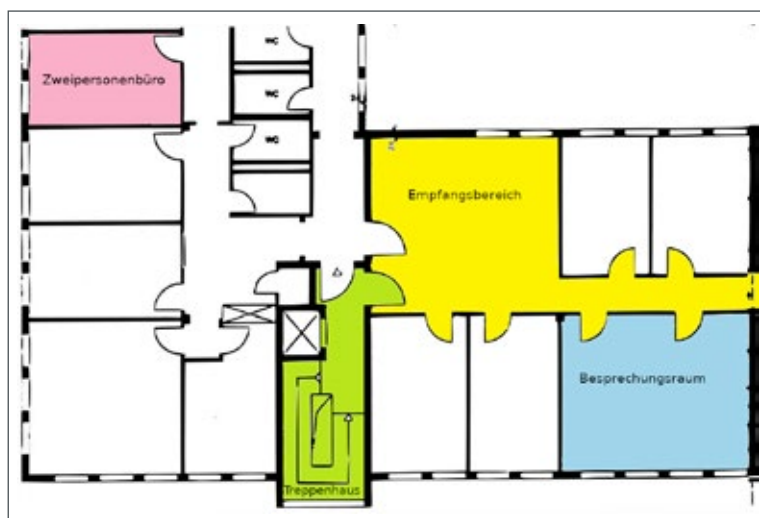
Grundrisse der Messräume Büro, Besprechungsraum, Empfang und Treppenhaus
